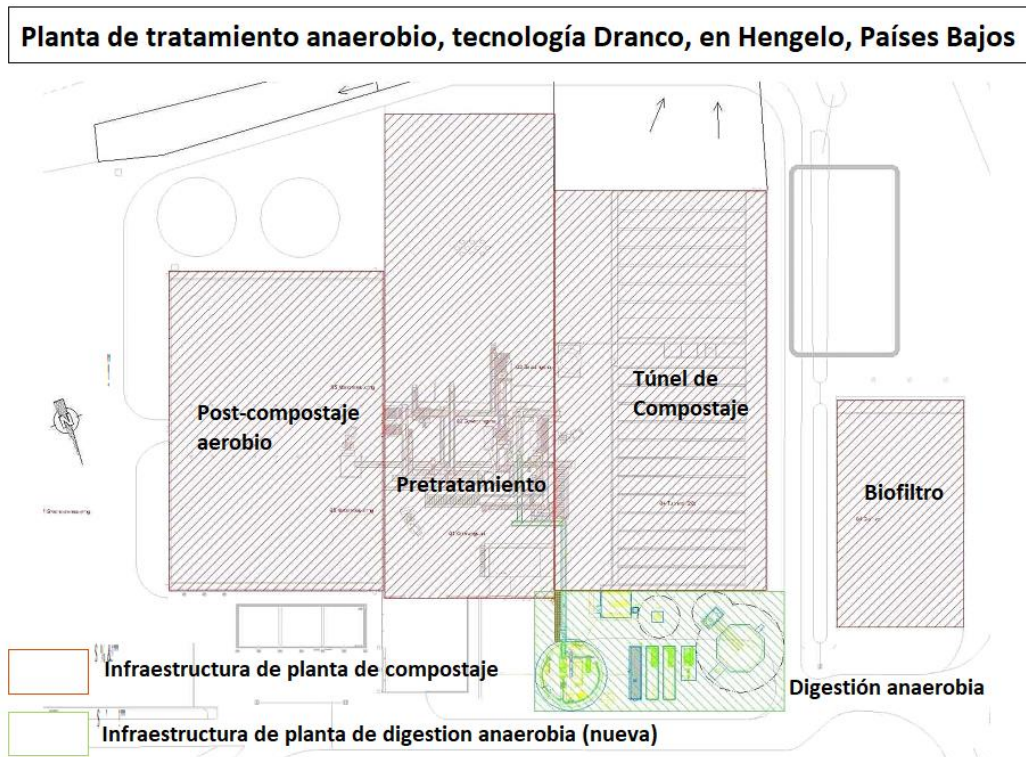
Distribución en planta de planta de tratamiento en Hengelo, Países Bajos
